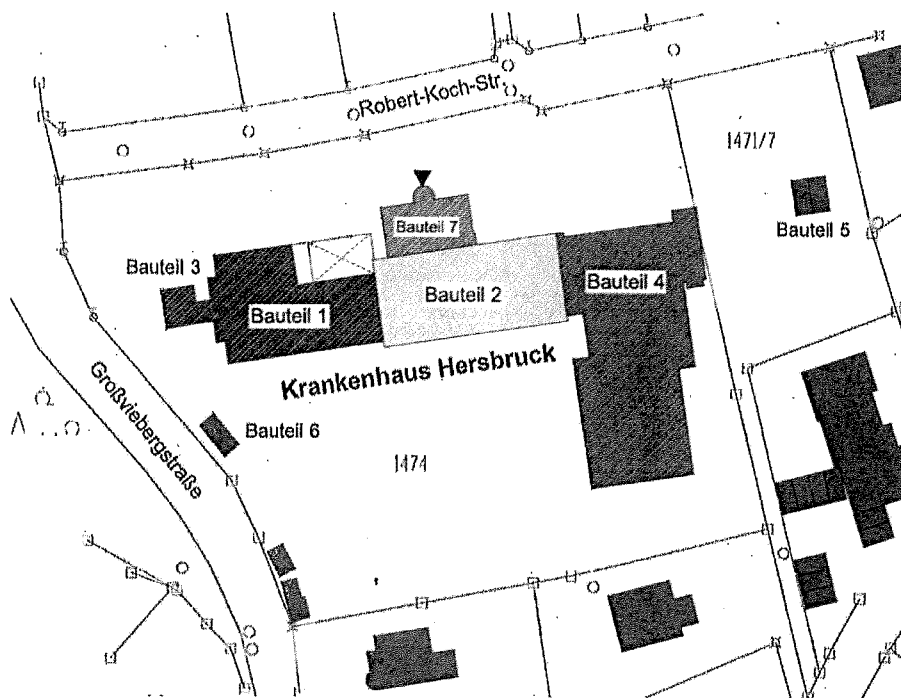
Lageplan mit Bezeichnung der Bauteile¹⁴
